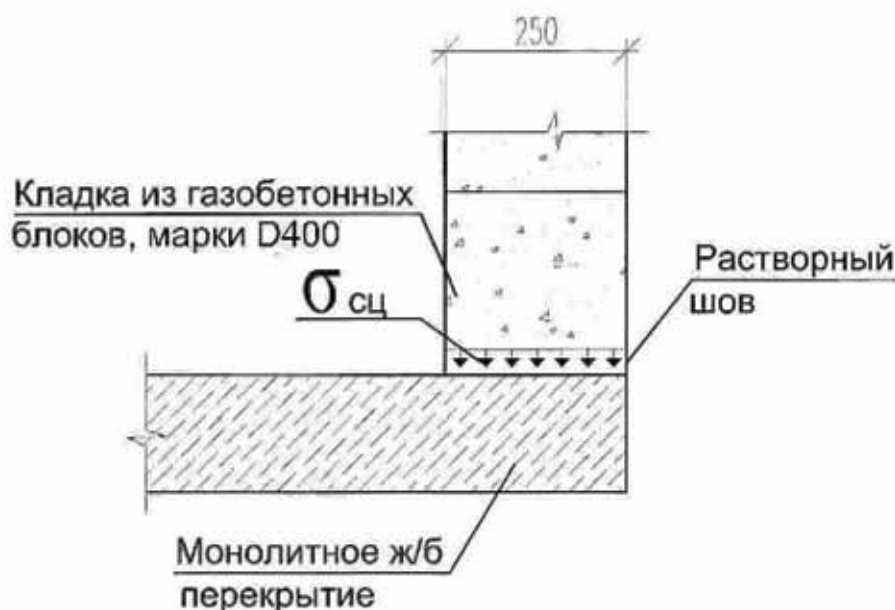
Схема сцепления первого ряда кладки с монолитным перекрытием
